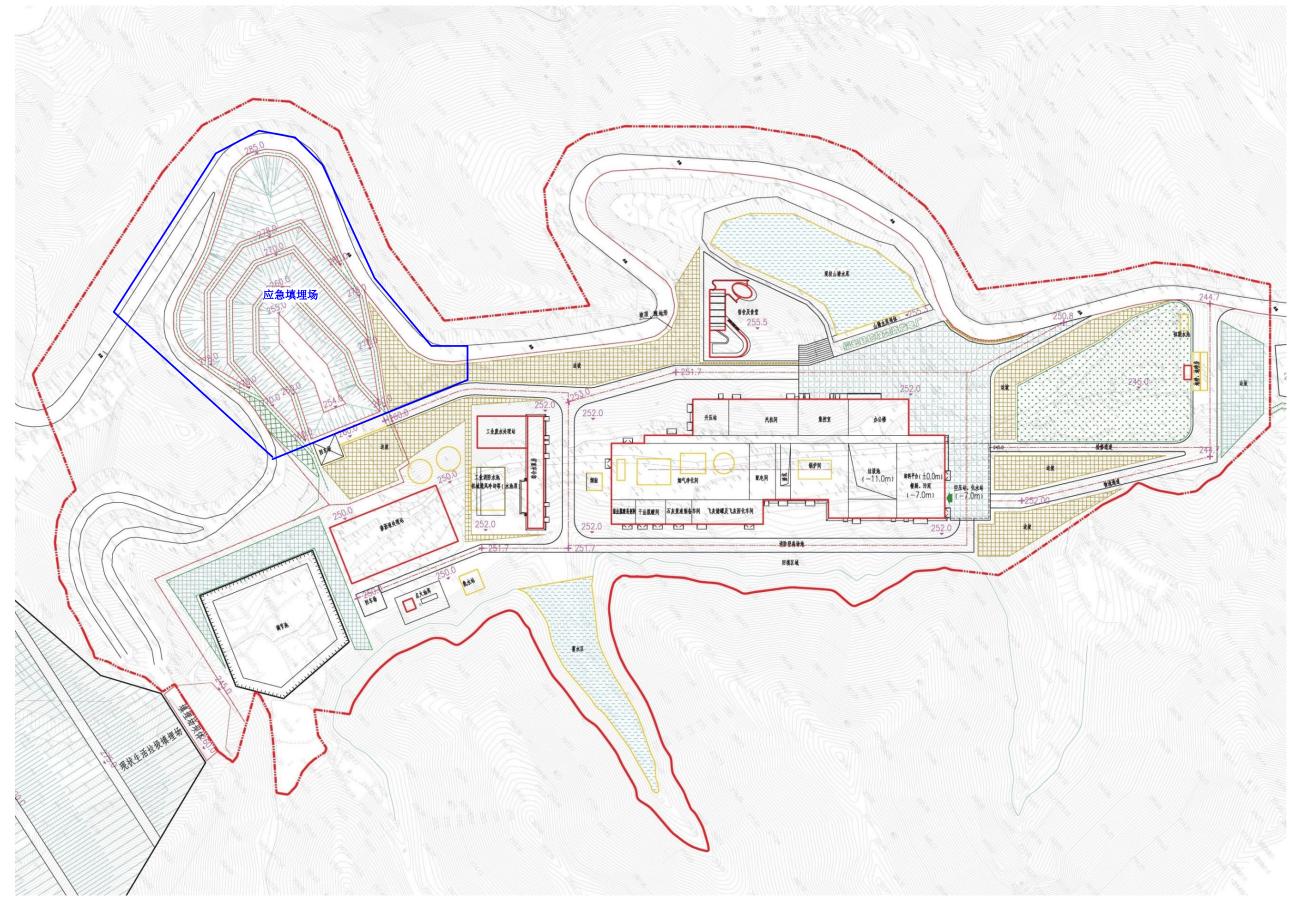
厂区总平面布置图 (注:应急填埋场不在本次评价范围内)
